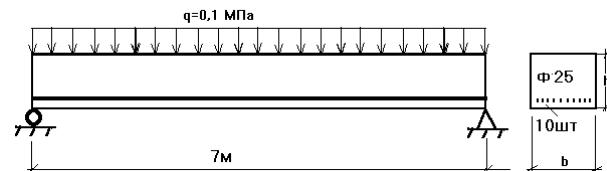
Конструкция железобетонной балки с одиночным армированием.
